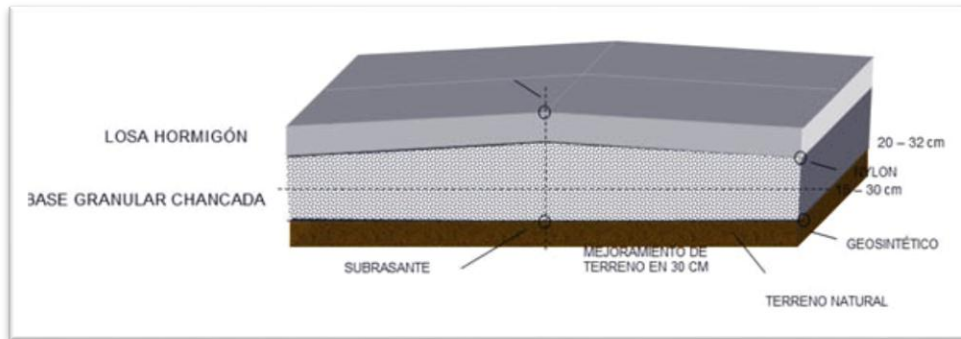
Pavimento Rígido (Hormigón)²
